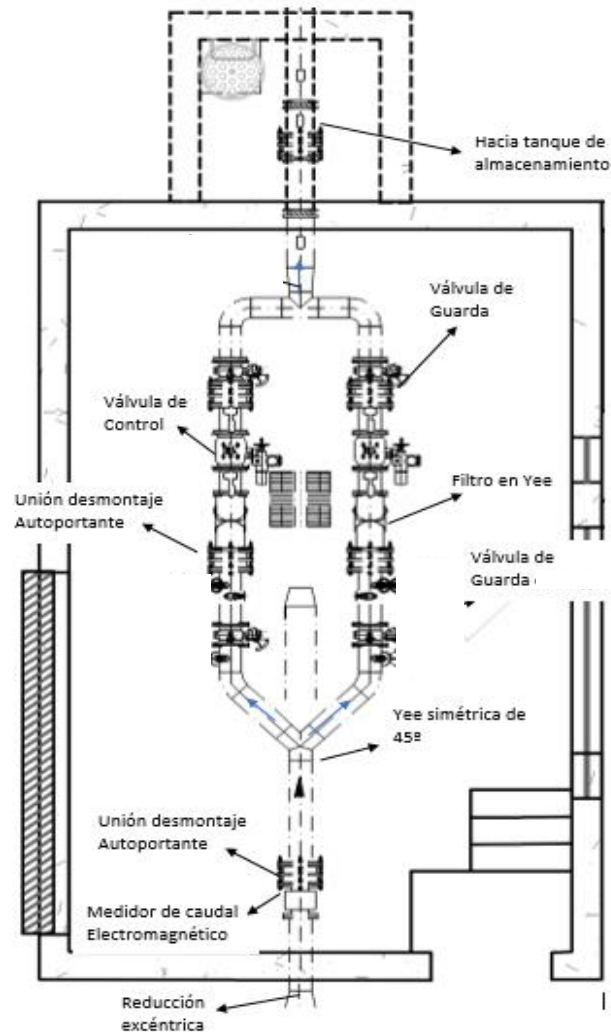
Configuración tipo de una Estructura de Control Vista en Planta
